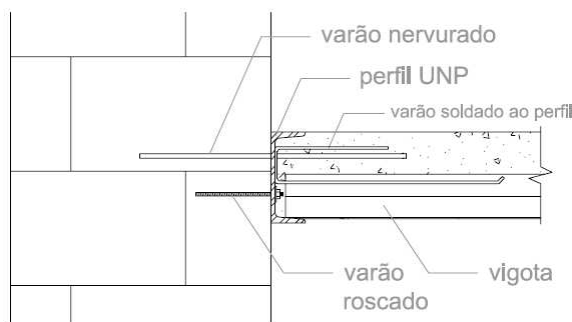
Apoio da laje aligeirada através de perfil U.
